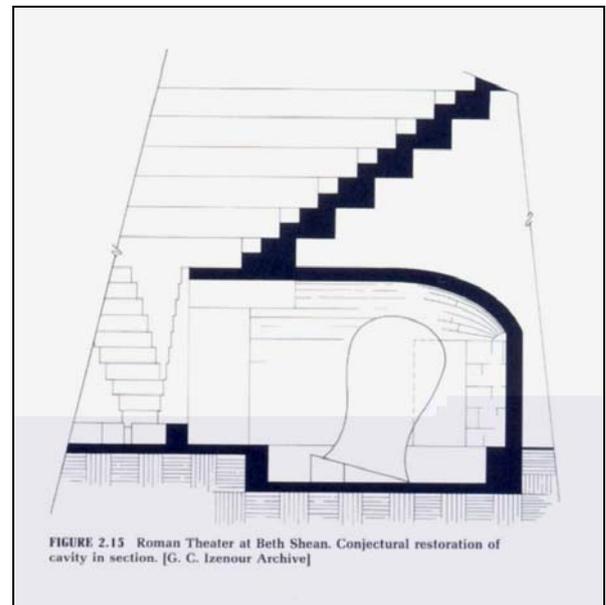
Corte da cavidade, restauração conjectural do vaso ressonador, de Beth Shean.
